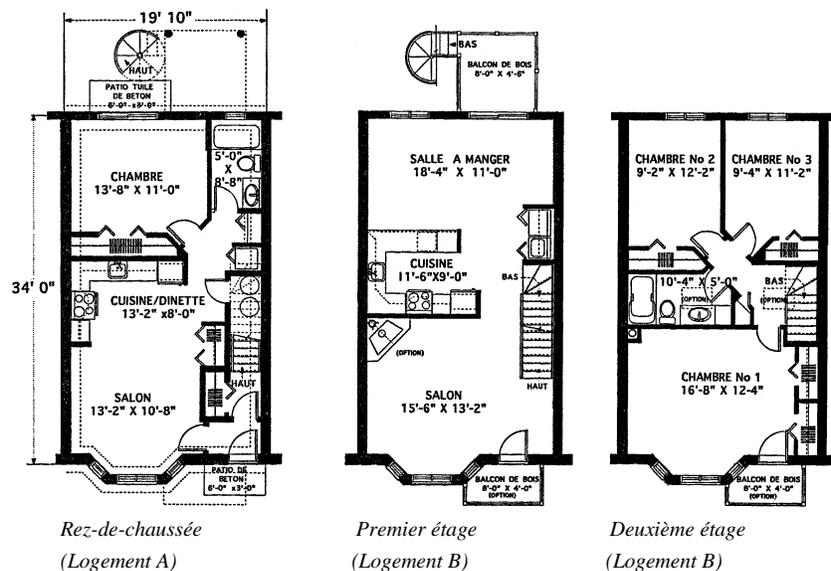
Exemples d'organisations possibles (La Presse, 29 avril 2000, section K).
